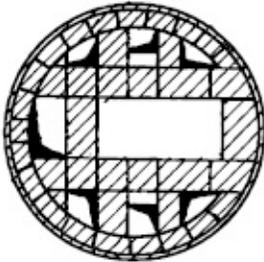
(продолжение). Кладка отопительной круглой печи в металлическом футляре
